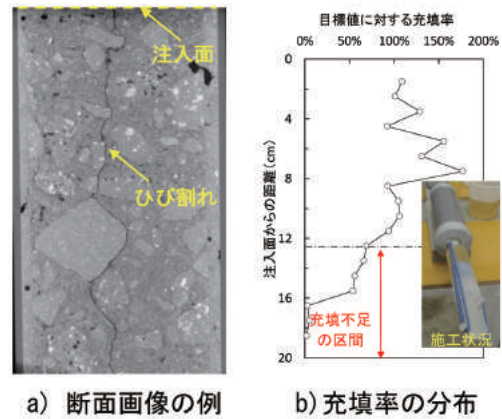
ひび割れ注入材により補修されたコンクリートのX線CTによる観察
